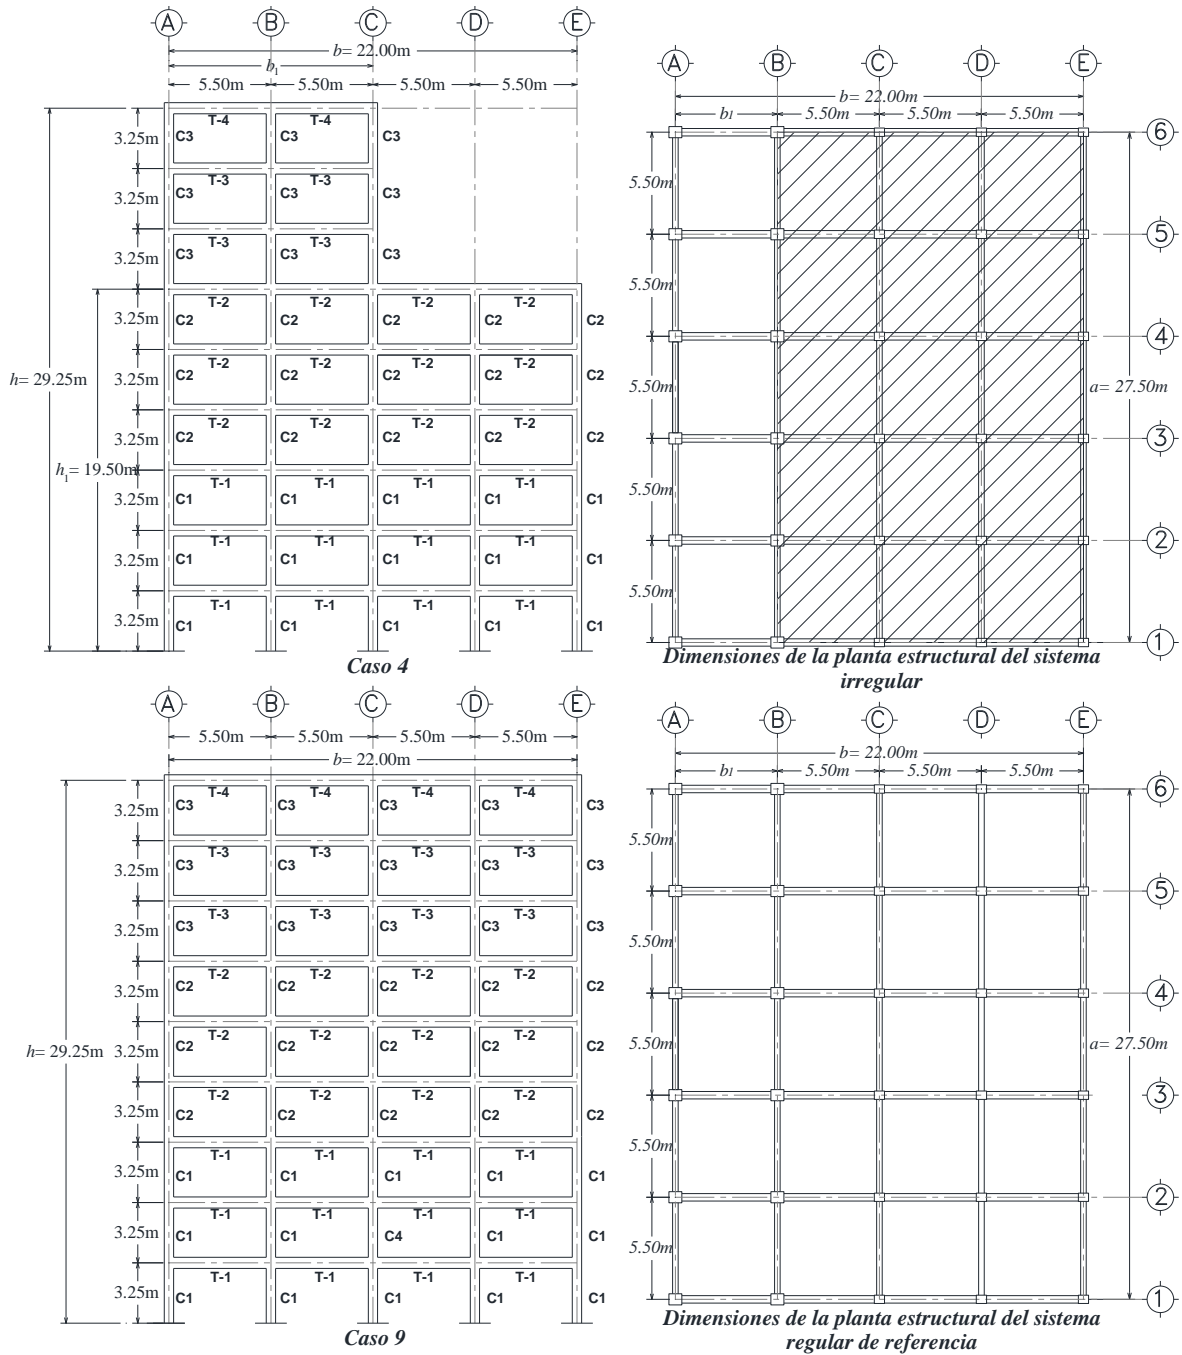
Nomenclatura de las secciones transversales finales de vigas y columnas de los casos 4 y 9
